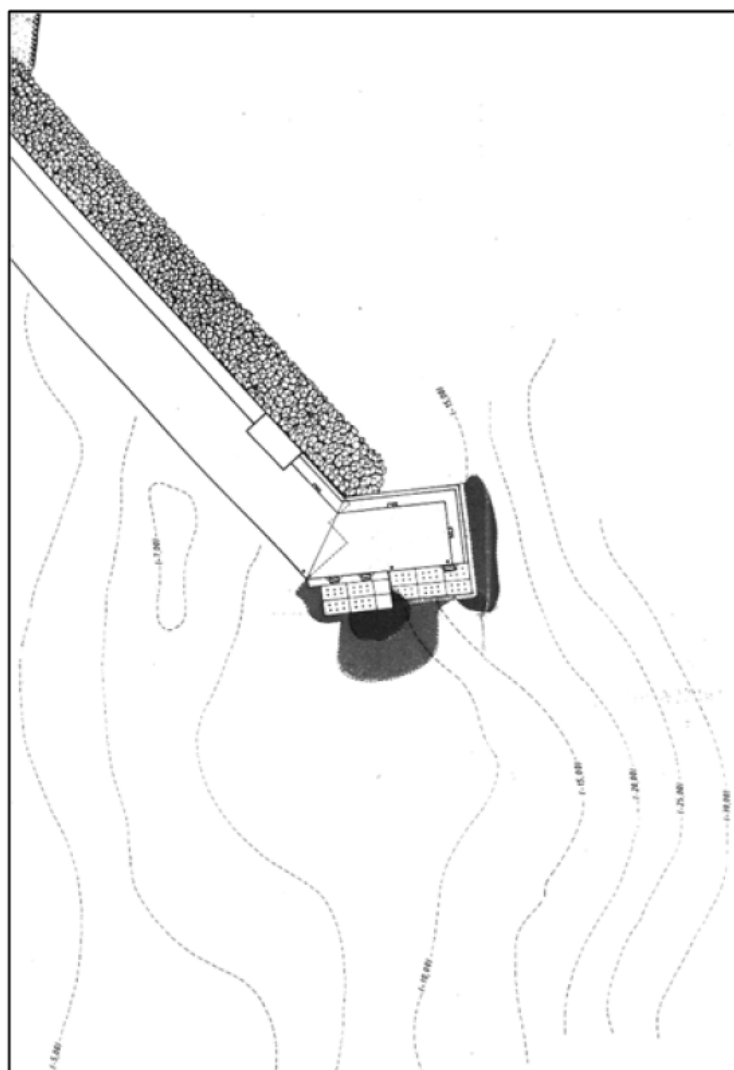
Planimetria del molo di mezzogiorno – Progetto 1988
